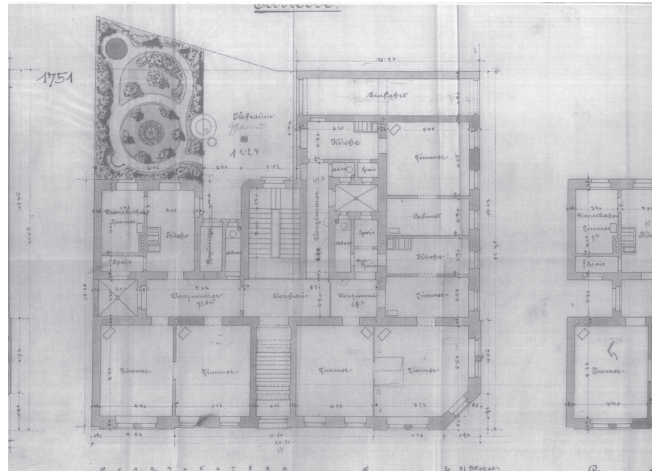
Konsensplan mit Erdgeschoßgrundriss eines Gründerzeitgebäudes
